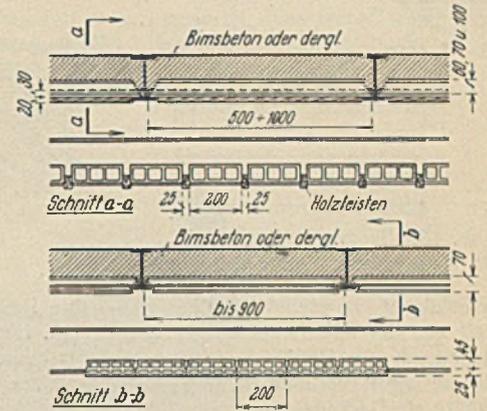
Houredisdecken der Pariser Stahlskelettbauten.
